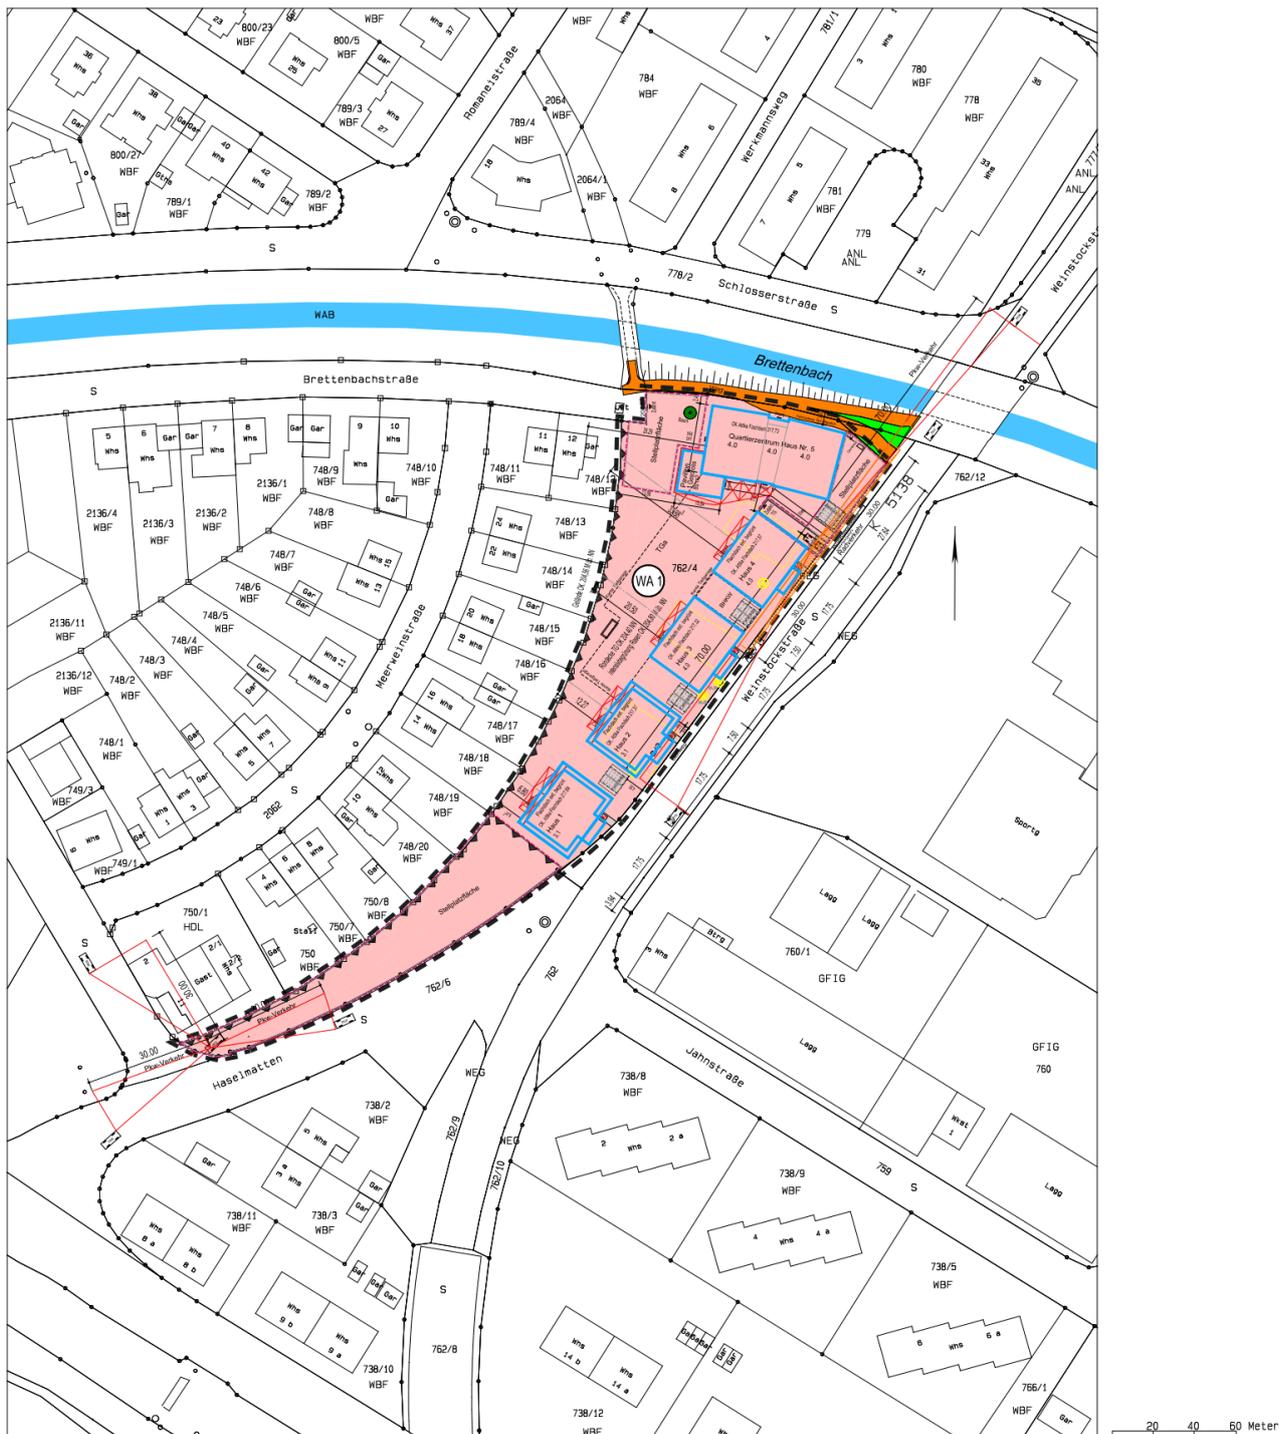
Bebauungsplanentwurf „Weinstockstraße“ vom 4.06.2018.
